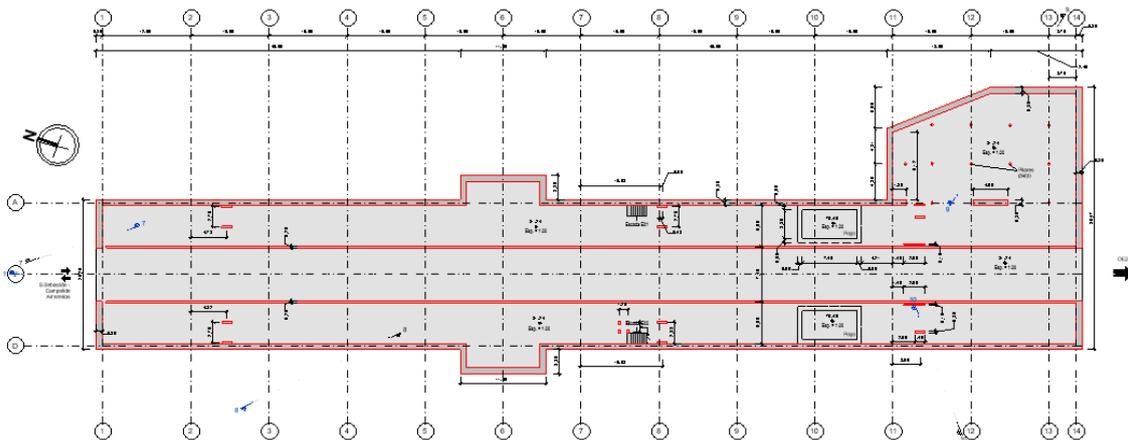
Planta ao nível do sub-cais (cota de topo do ensoleiramento geral)
